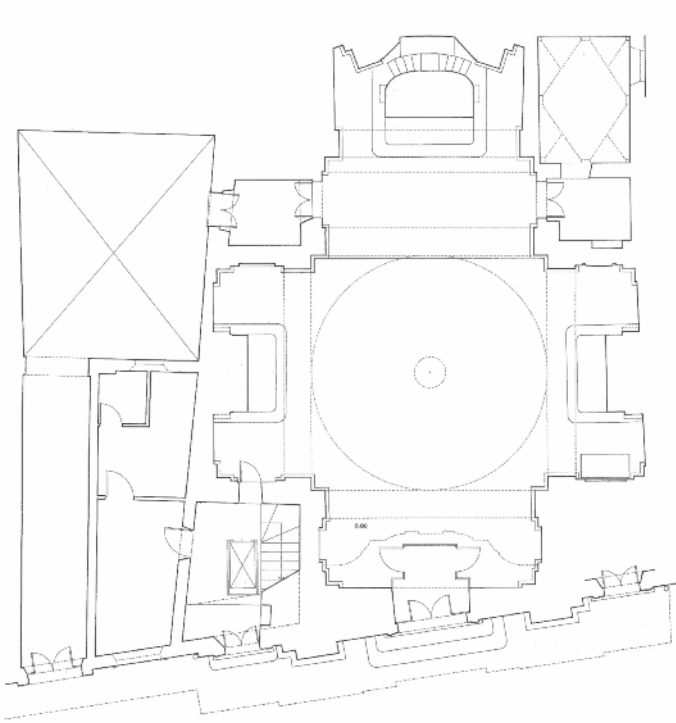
Planimetria del complesso a quota + 1.0 m (rilievo dell'autore).
